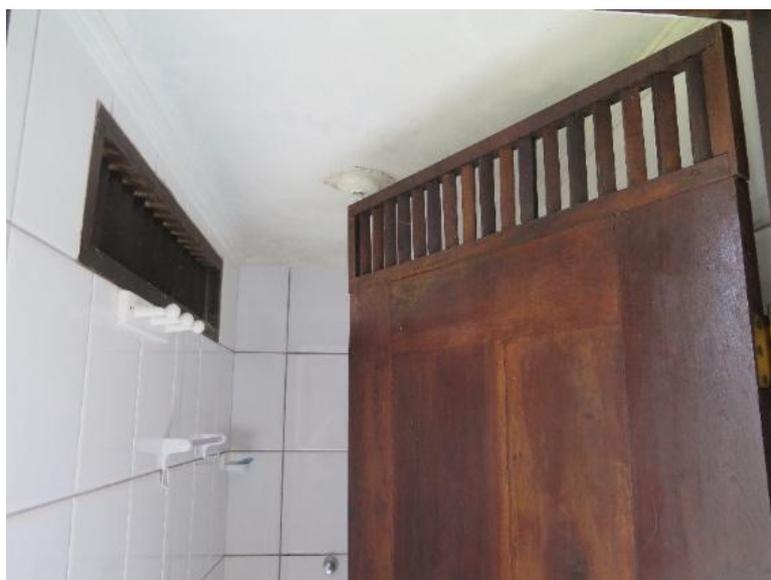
Detalhe da ventilação na porta e parede. Em madeira. Fonte: Fotografia do autor
